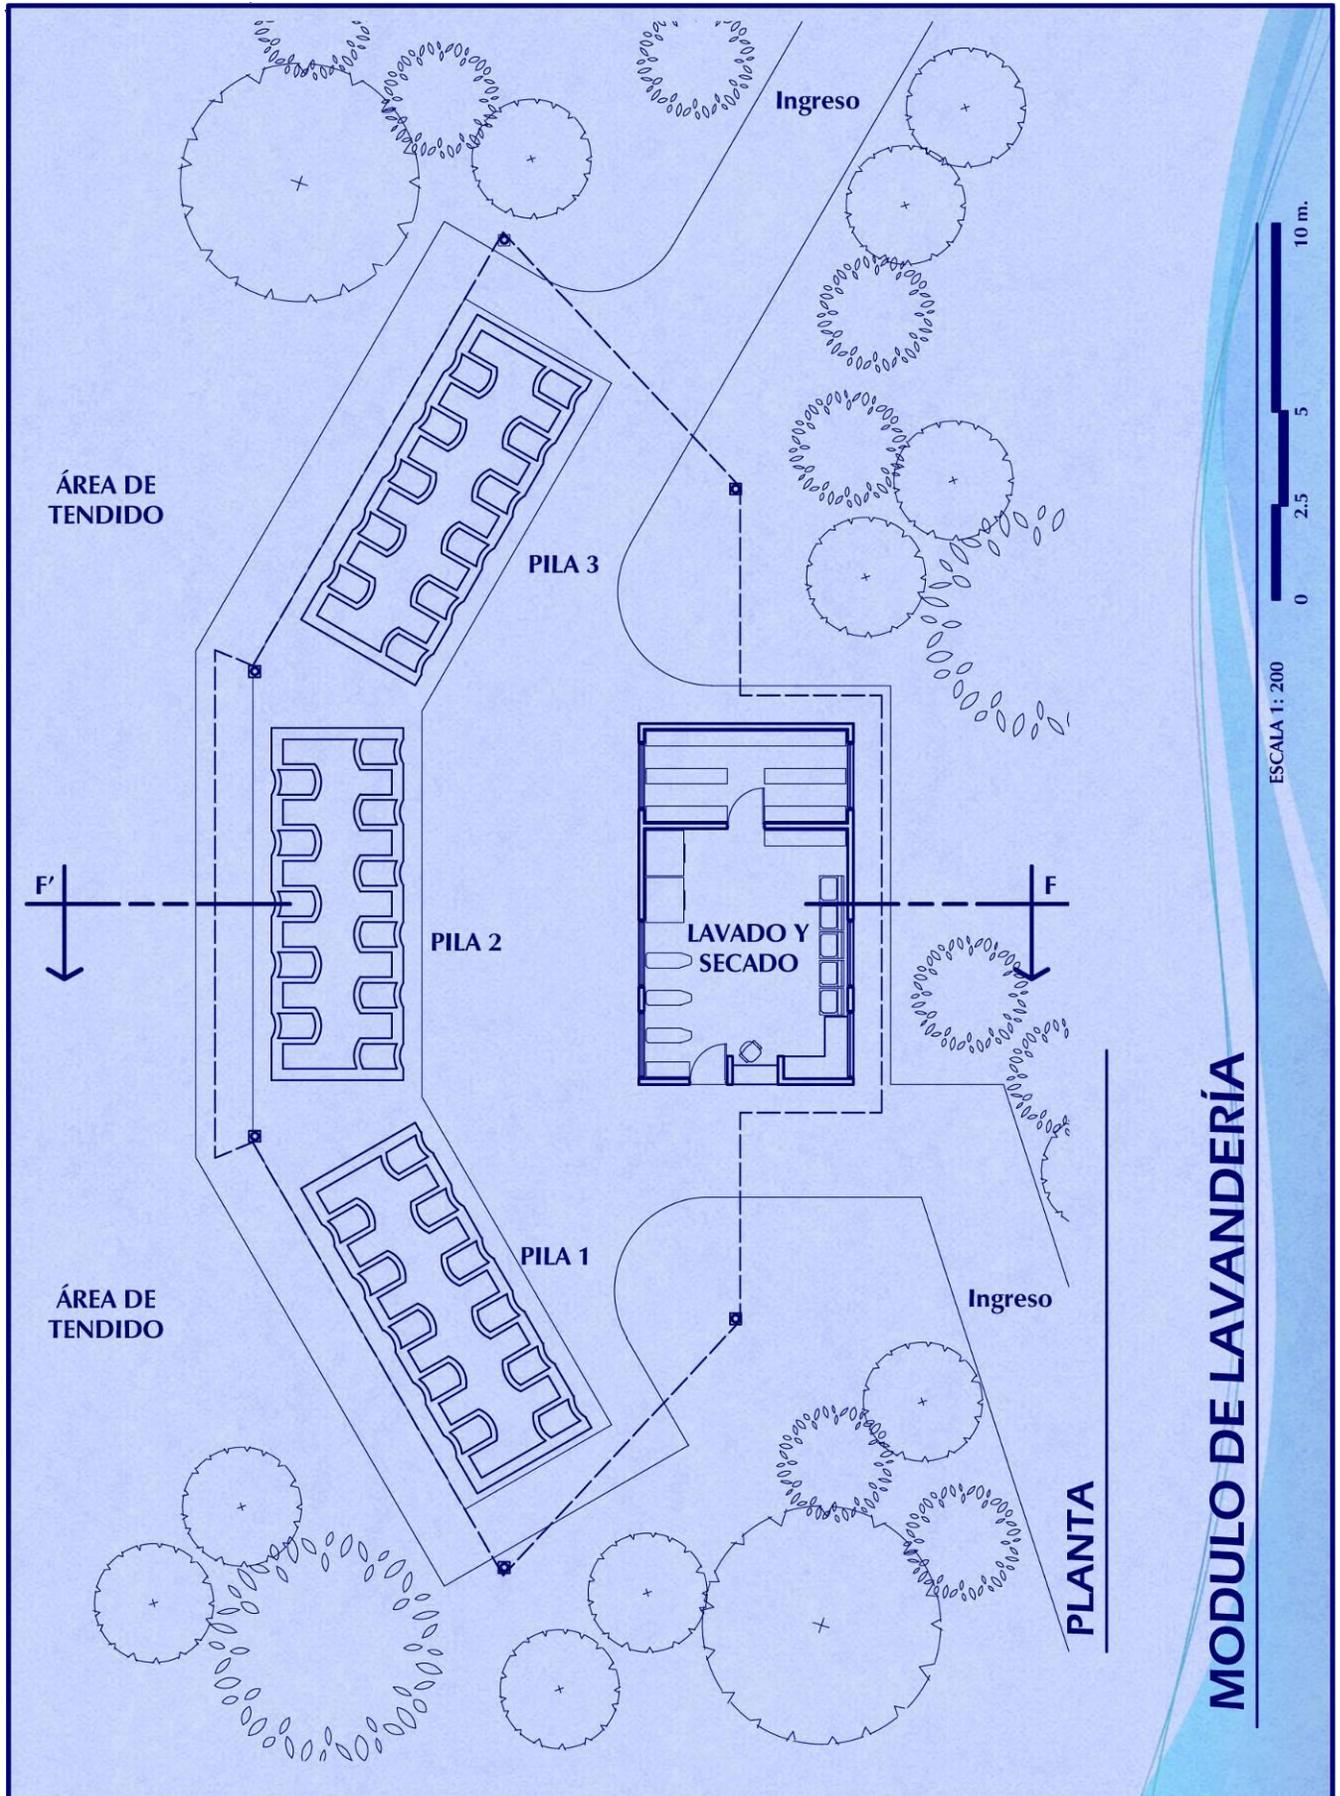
Anteproyecto para las Lavanderías, Planta Amueblada.
